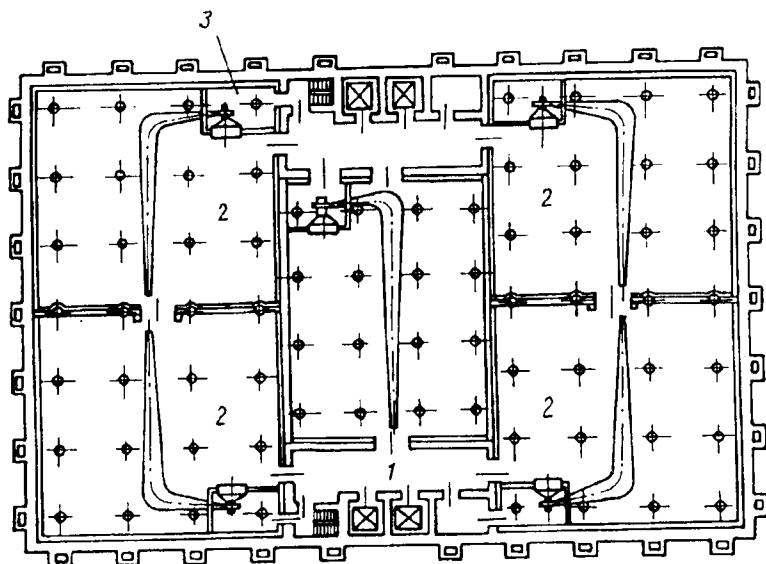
Планировка этажа здания с воздушным охлаждением:
